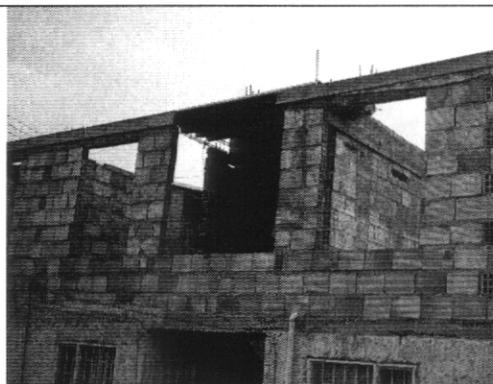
Apartamentos en terceros pisos sin terminar con fachadas sueltas.
